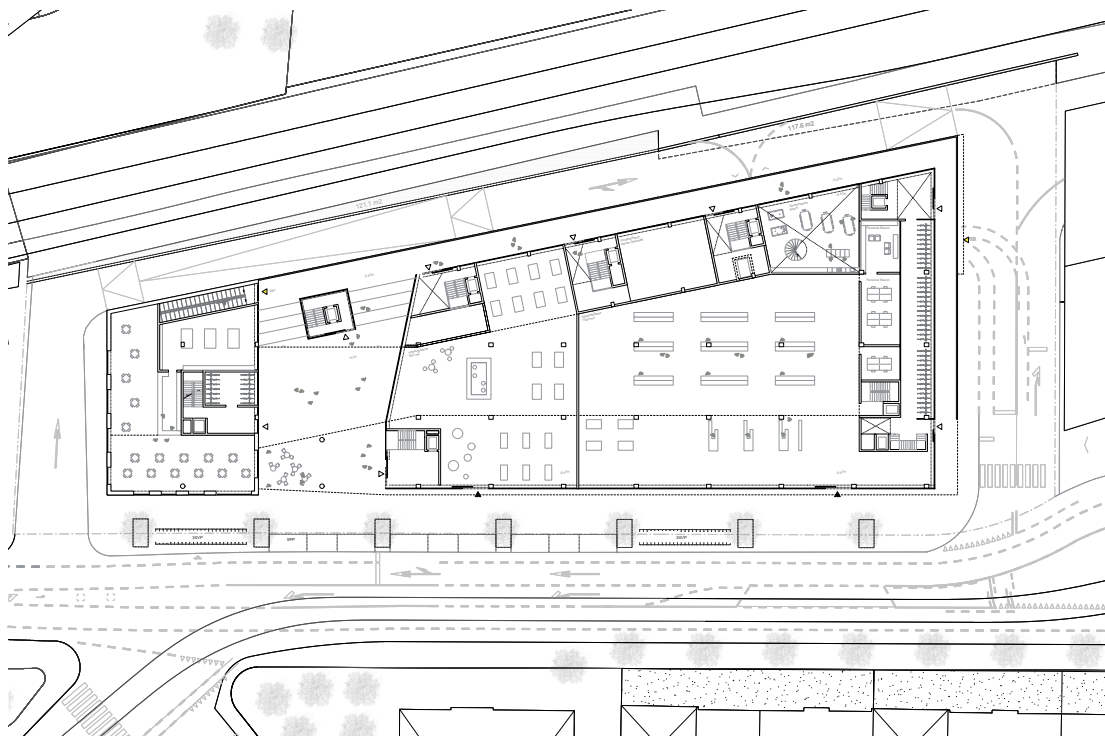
Grundriss Erdgeschoss (Strassenniveau)
